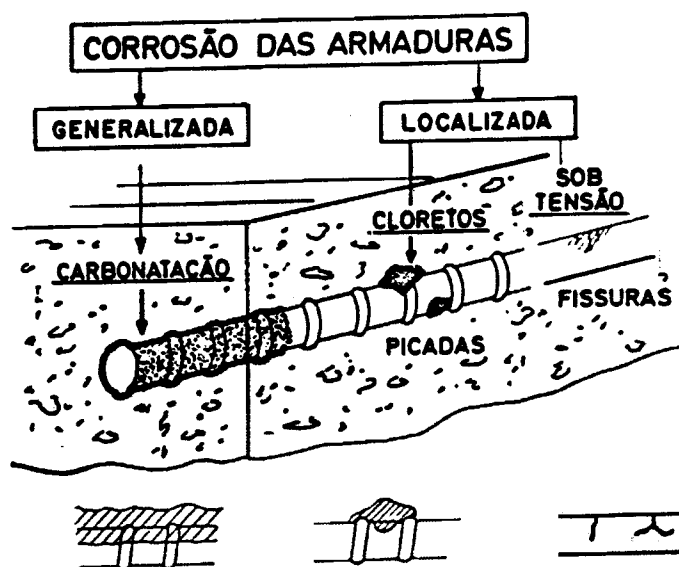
Tipos de corrosão das armaduras do betão.
